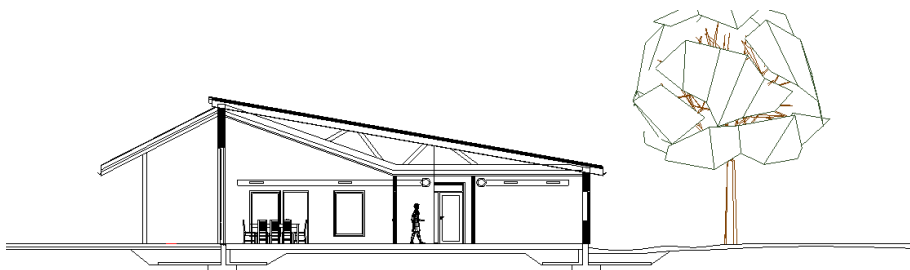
Fasade øst og vest Høgegga barnehage 4 evellingeravdelinger
